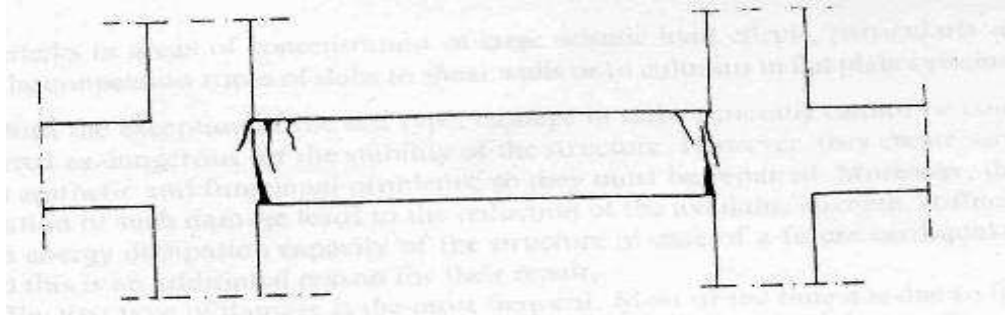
Fissures de Flexion sur les faces supérieure ou inférieure aux appuis de la poutre.
